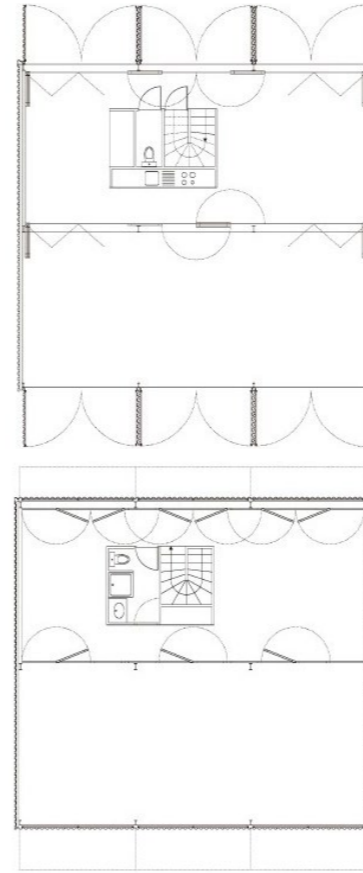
Planta baja y planta primera. Los cerramientos componen un sistema móvil que permite la adaptación
